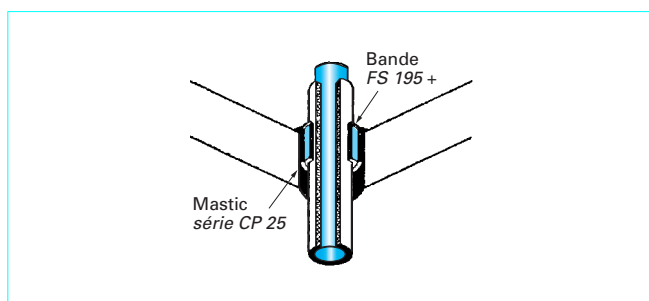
Conduit isolant traversant un plancher (doc. 3M)
